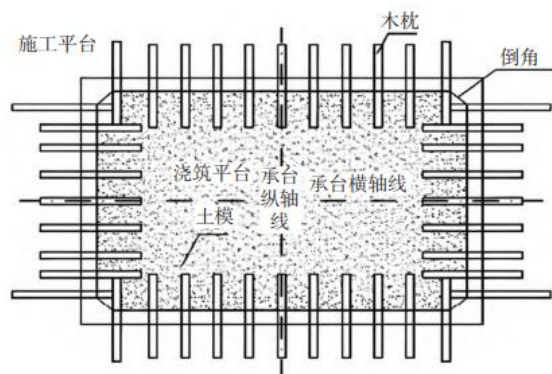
钢筋混凝土结构的水利工程围堰施工平台
